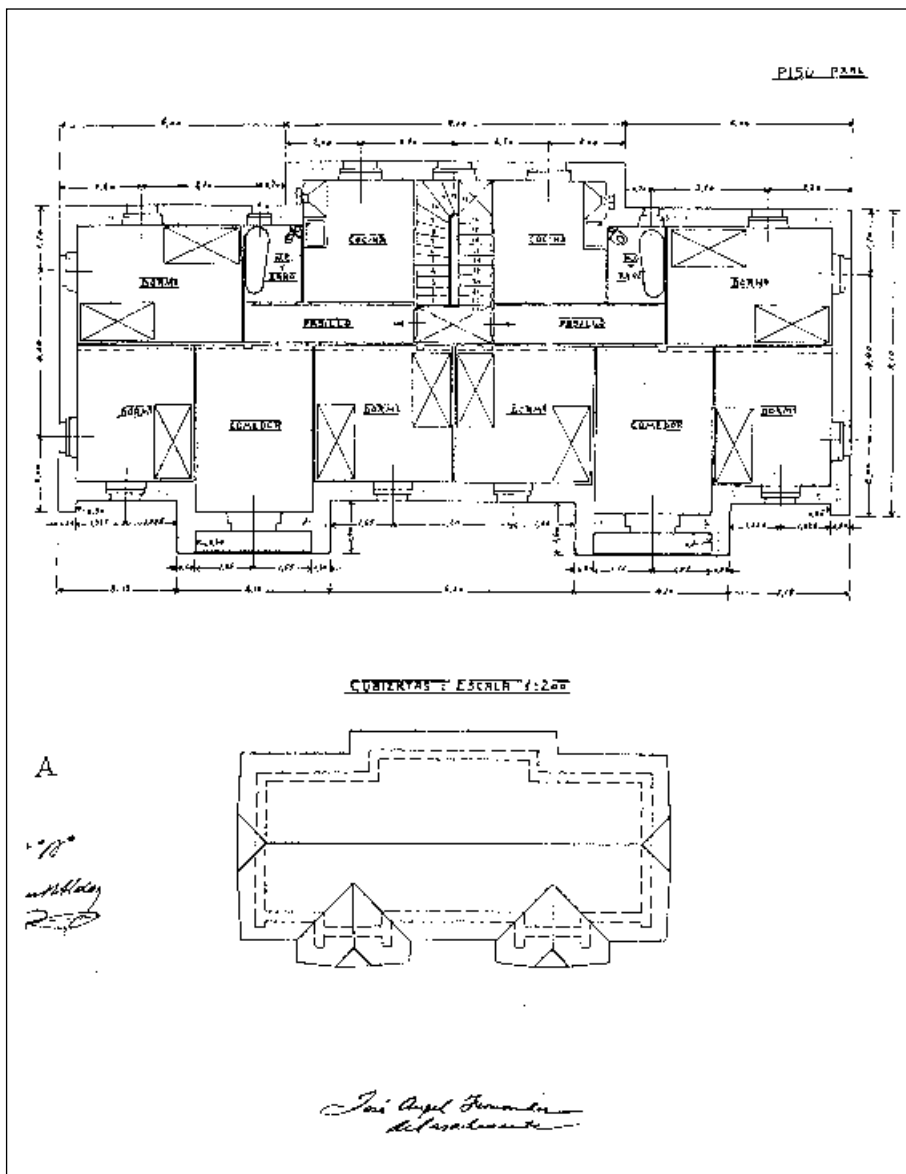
Planos de la villa B. Arquitecto José Ángel Fernández de Casadevante.
